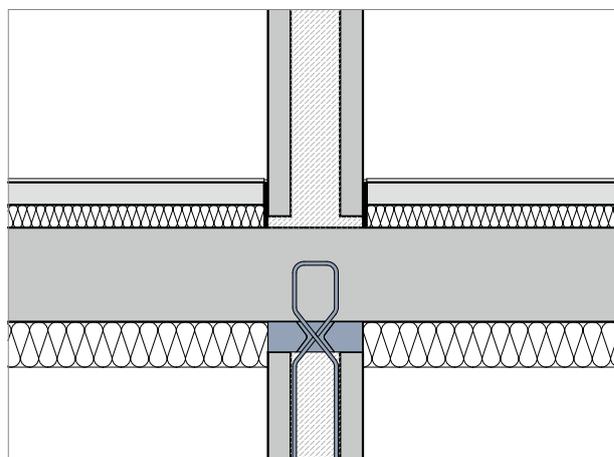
Représentation schématique d'un système Schöck Sconnex® type W pour doubles murs et isolation sous la dalle
